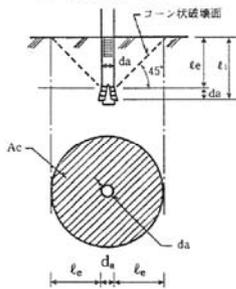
天端被覆コンクリート差し筋施工要領
